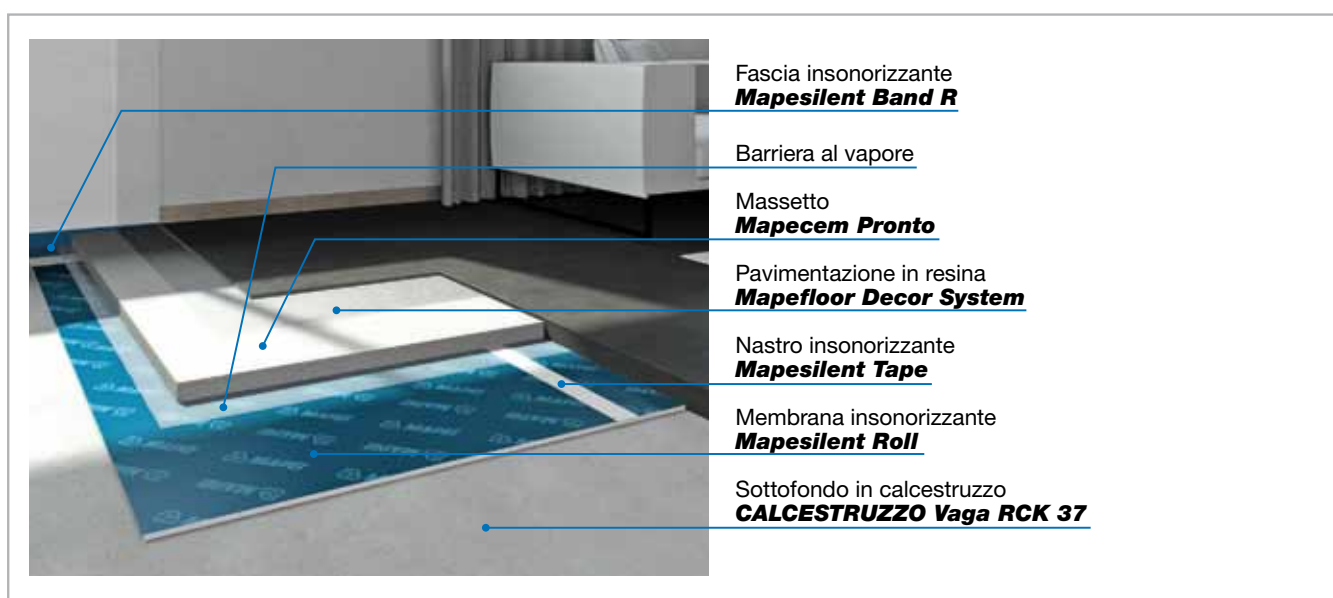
Massetto galleggiante isolato acusticamente con Sistema MAPESILENT
